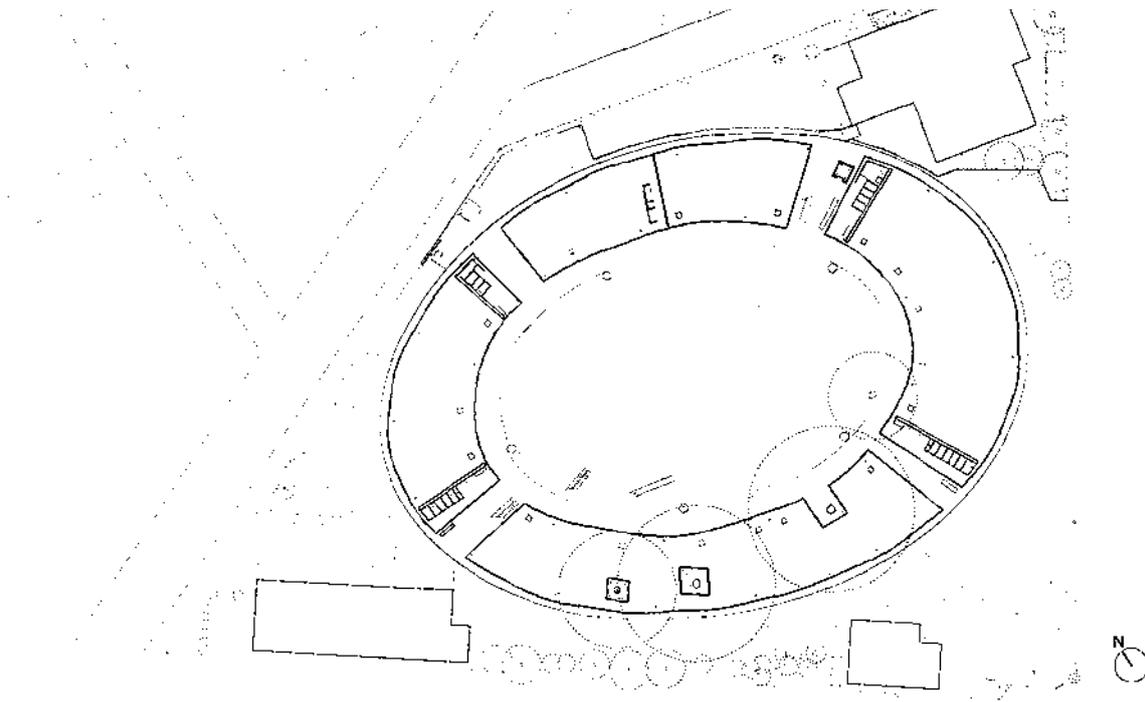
Planta de conjunto. Fuente: Archdaily.
